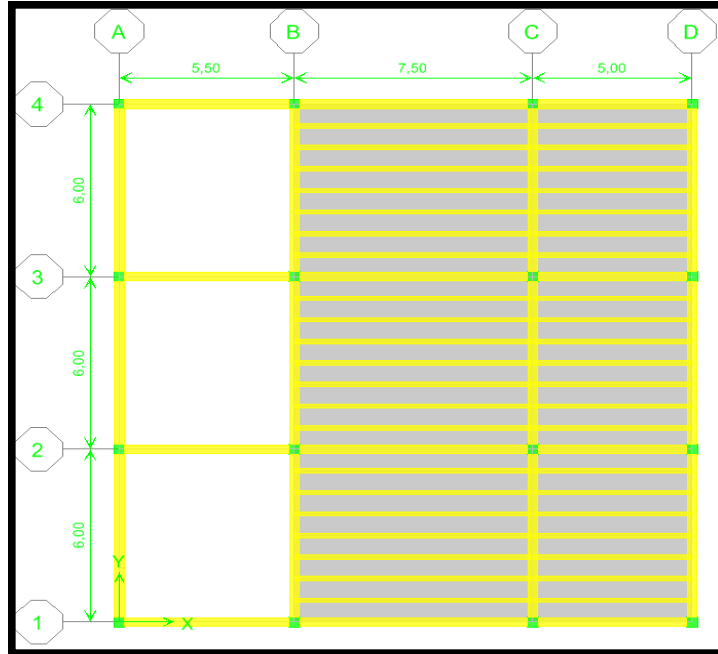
Planta de Nueva Configuración Pasarela 2 (Edificio Norte)
